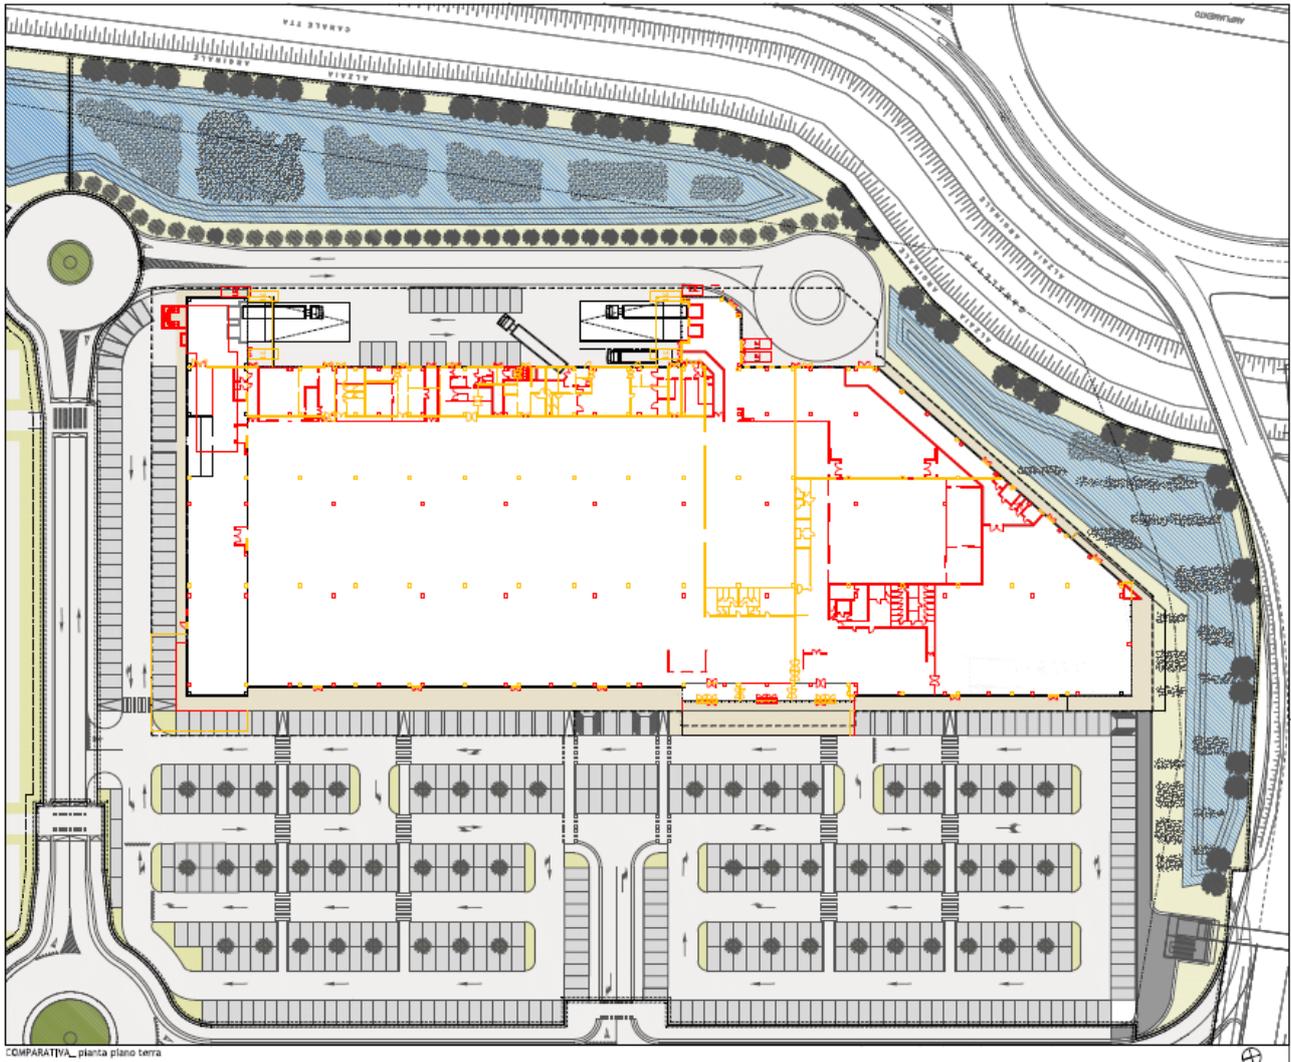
Tavola comparativa - pianta piano terra (FONTE: elaborati Ing. Endrizzi)
